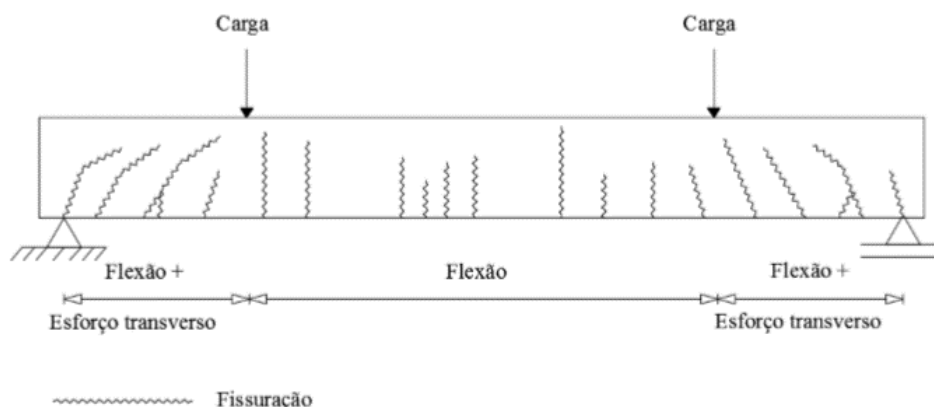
Fendilhação de uma viga (Silva, 2015)
